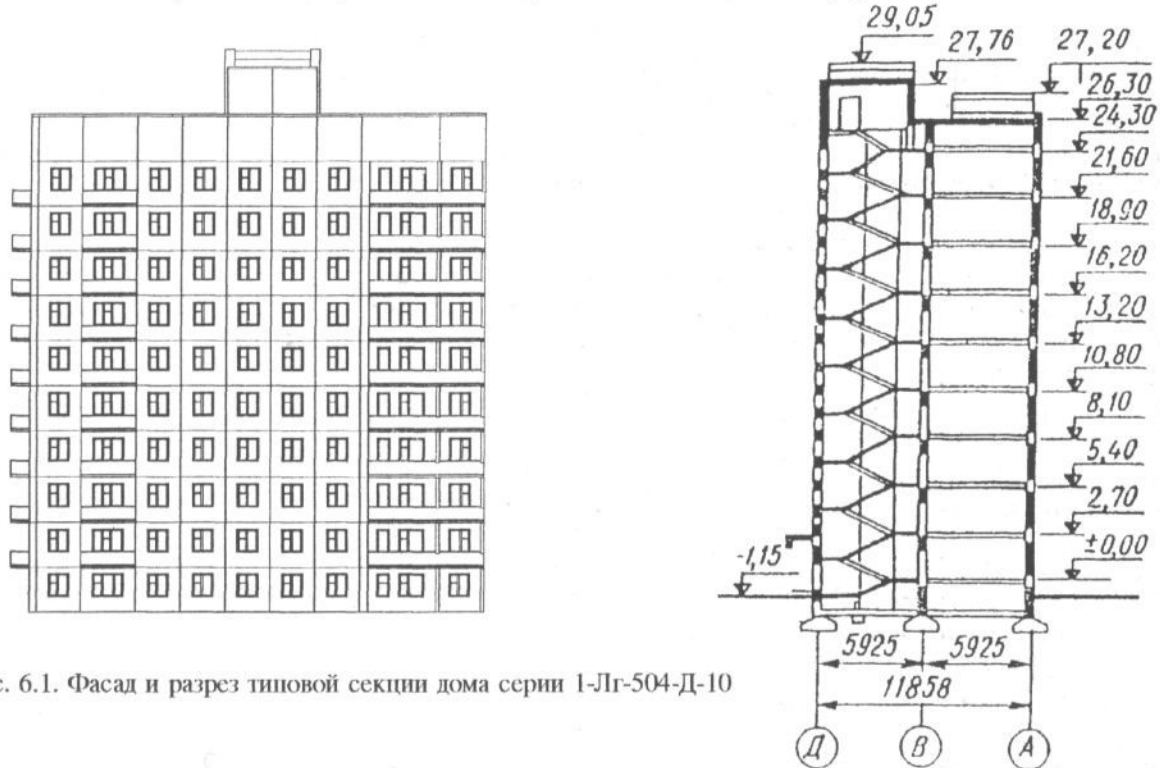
Фасад и разрез типовой секции дома серии 1-Лг-504-Д-10
